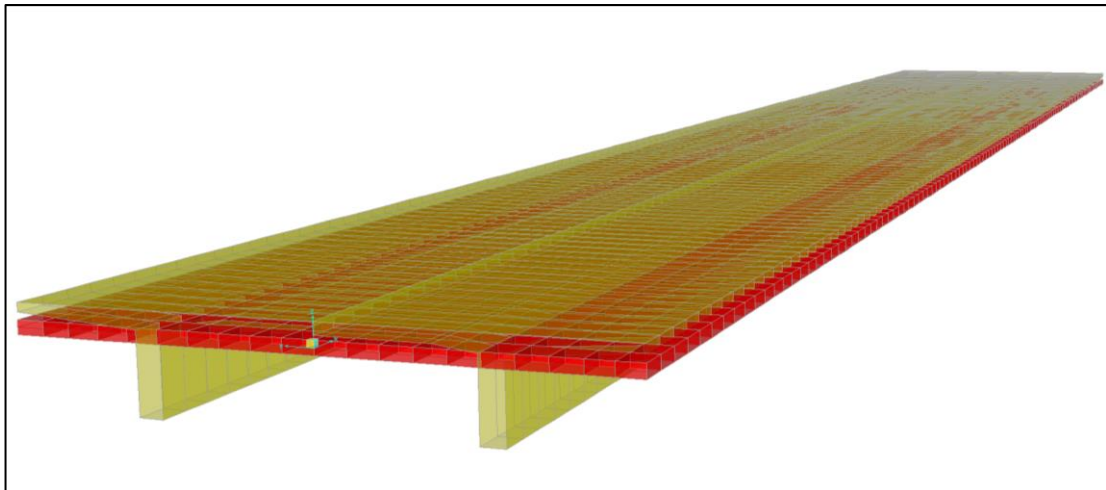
CASO 1 - Visualização da seção transversal do tabuleiro com adição de elementos de laje para unificação das vigas longitudinais. (SAP-2000)
